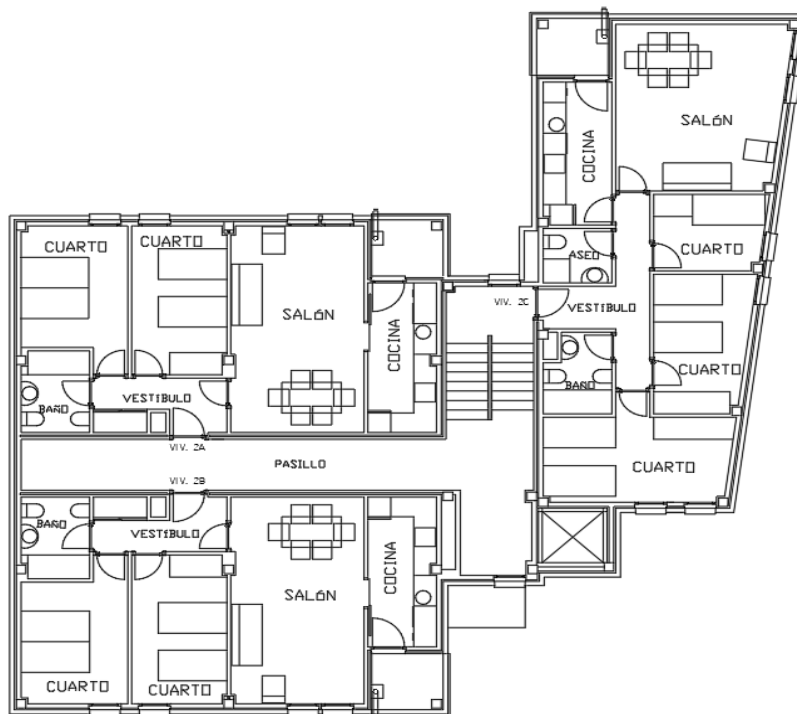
Distribución viviendas planta baja y 1º. Ilustración: Propia.
